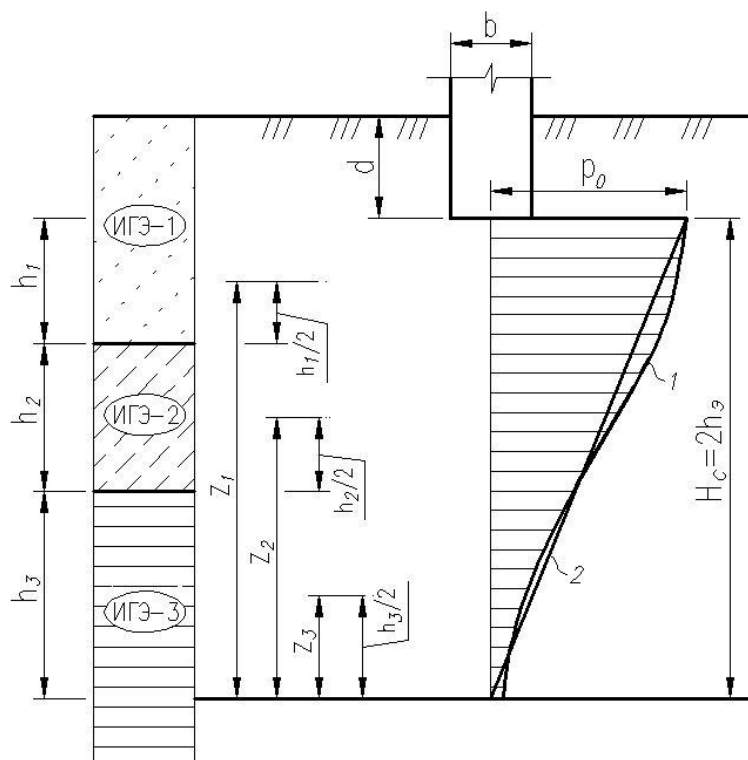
Схема к расчету осадки методом эквивалентного слоя для слоистого напластования грунтового основания:
